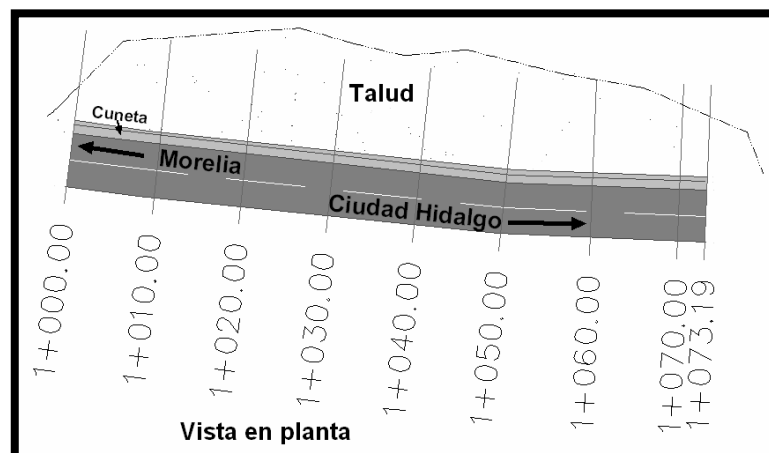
Vista en planta del talud "Los Cantiles 2".
